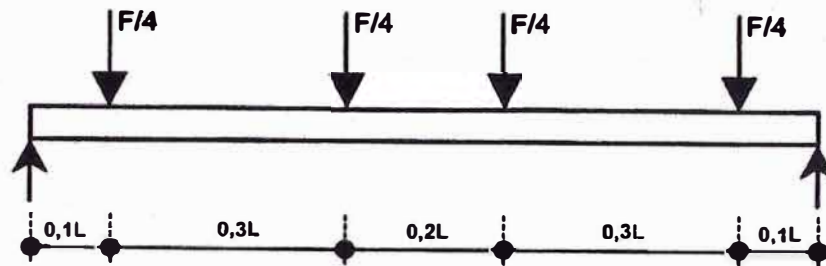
Panel simplemente apoyado: 4 cargas lineales (alternativa)
